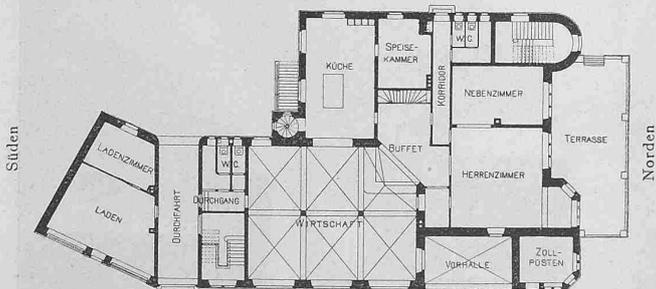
Grundriss vom Erdgeschoss. — Masstab 1 : 500.
